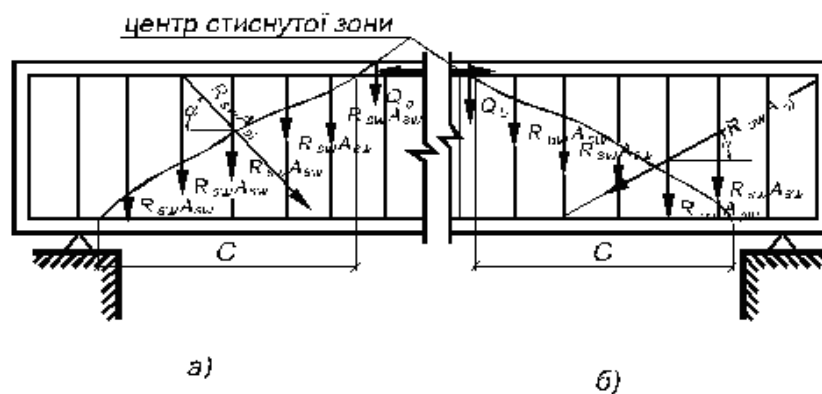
Розрахункова схема зусиль у перерізі, нахиленому до поздовжньої осі залізобетонного елемента, при розрахунку його міцності на дію поперечної сили
